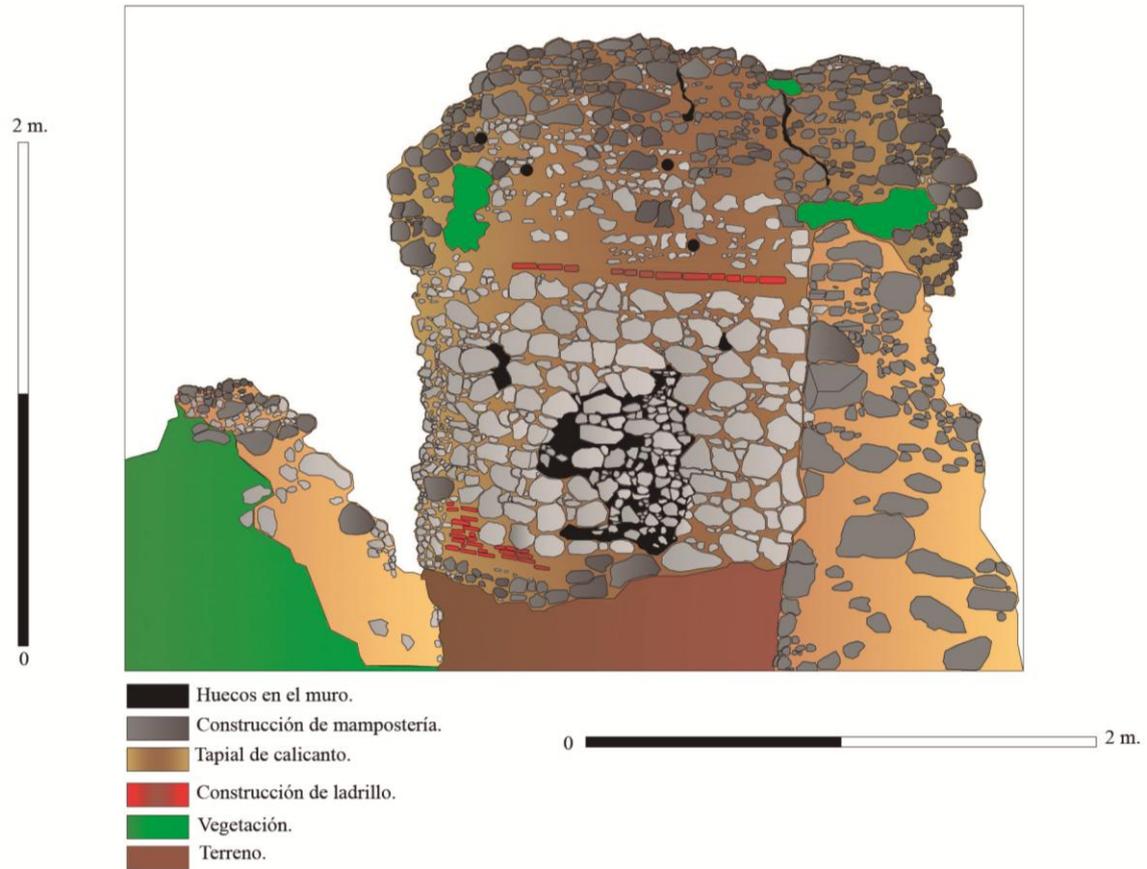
Alzado noreste interior de la puerta de la ciudad. (Elaboración propia).
